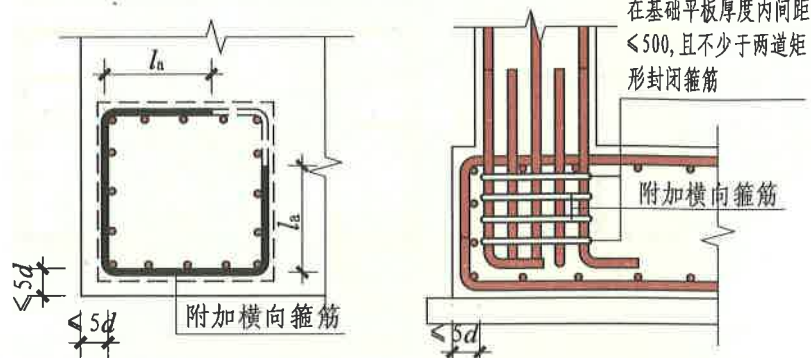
筏形基础有中间钢筋网时柱插筋排布构造
